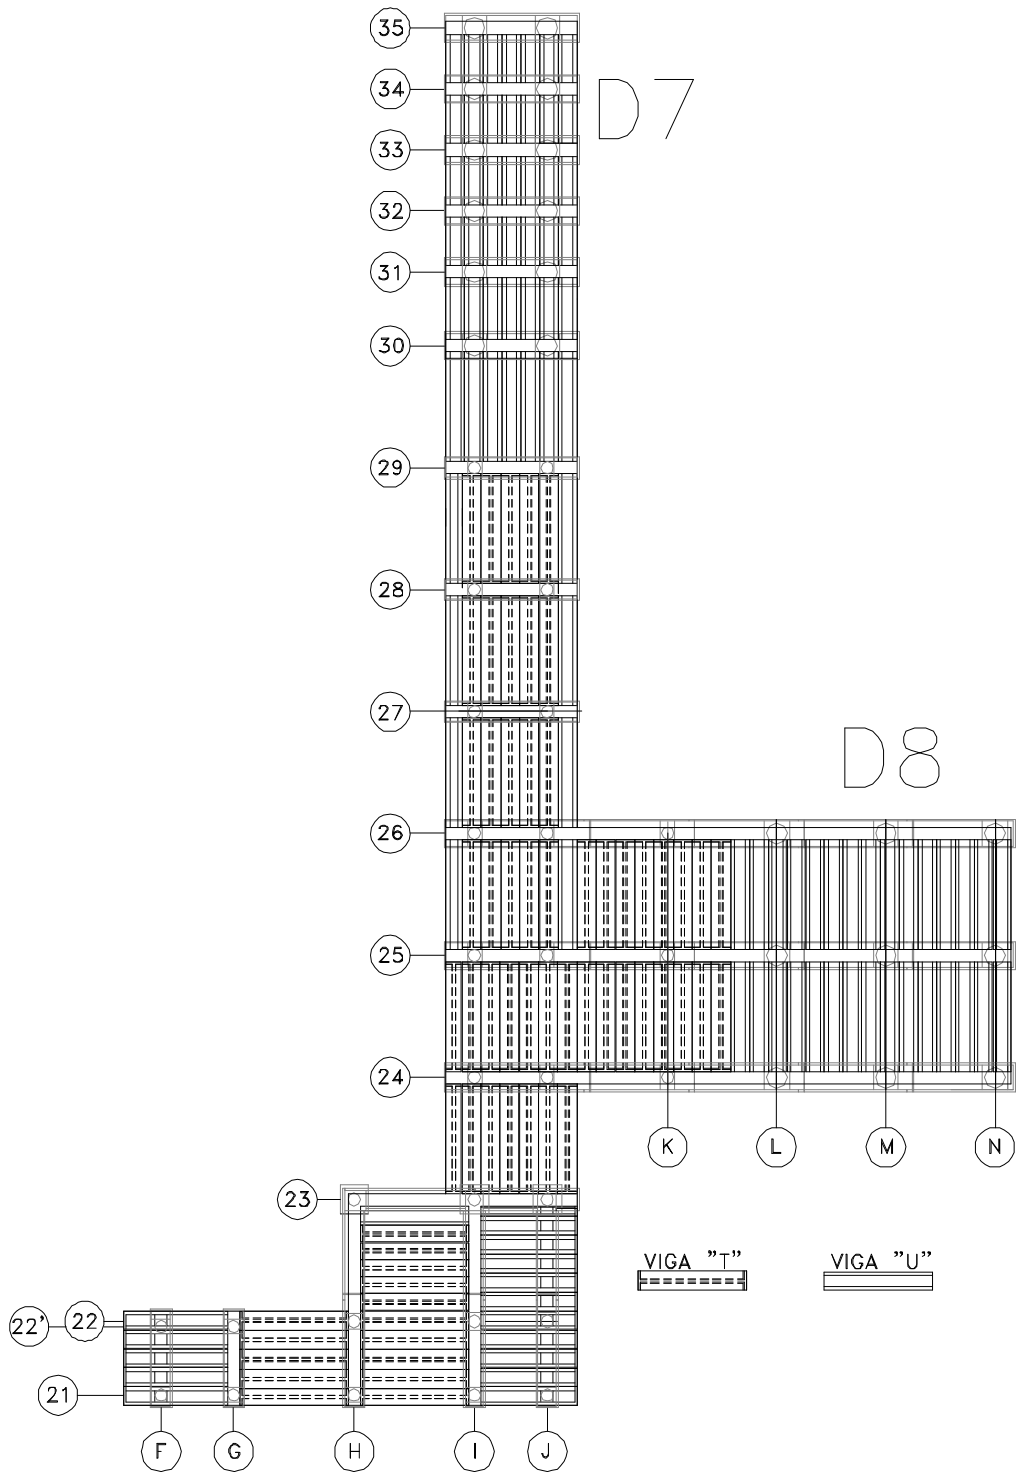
Locação de Vigas – Dolphins de Amarração – D7 e D8 – Projeto Final
